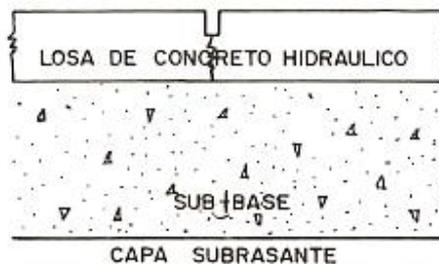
Esquema de las capas que forman un pavimento rígido, construido sobre la capa subrasante.
